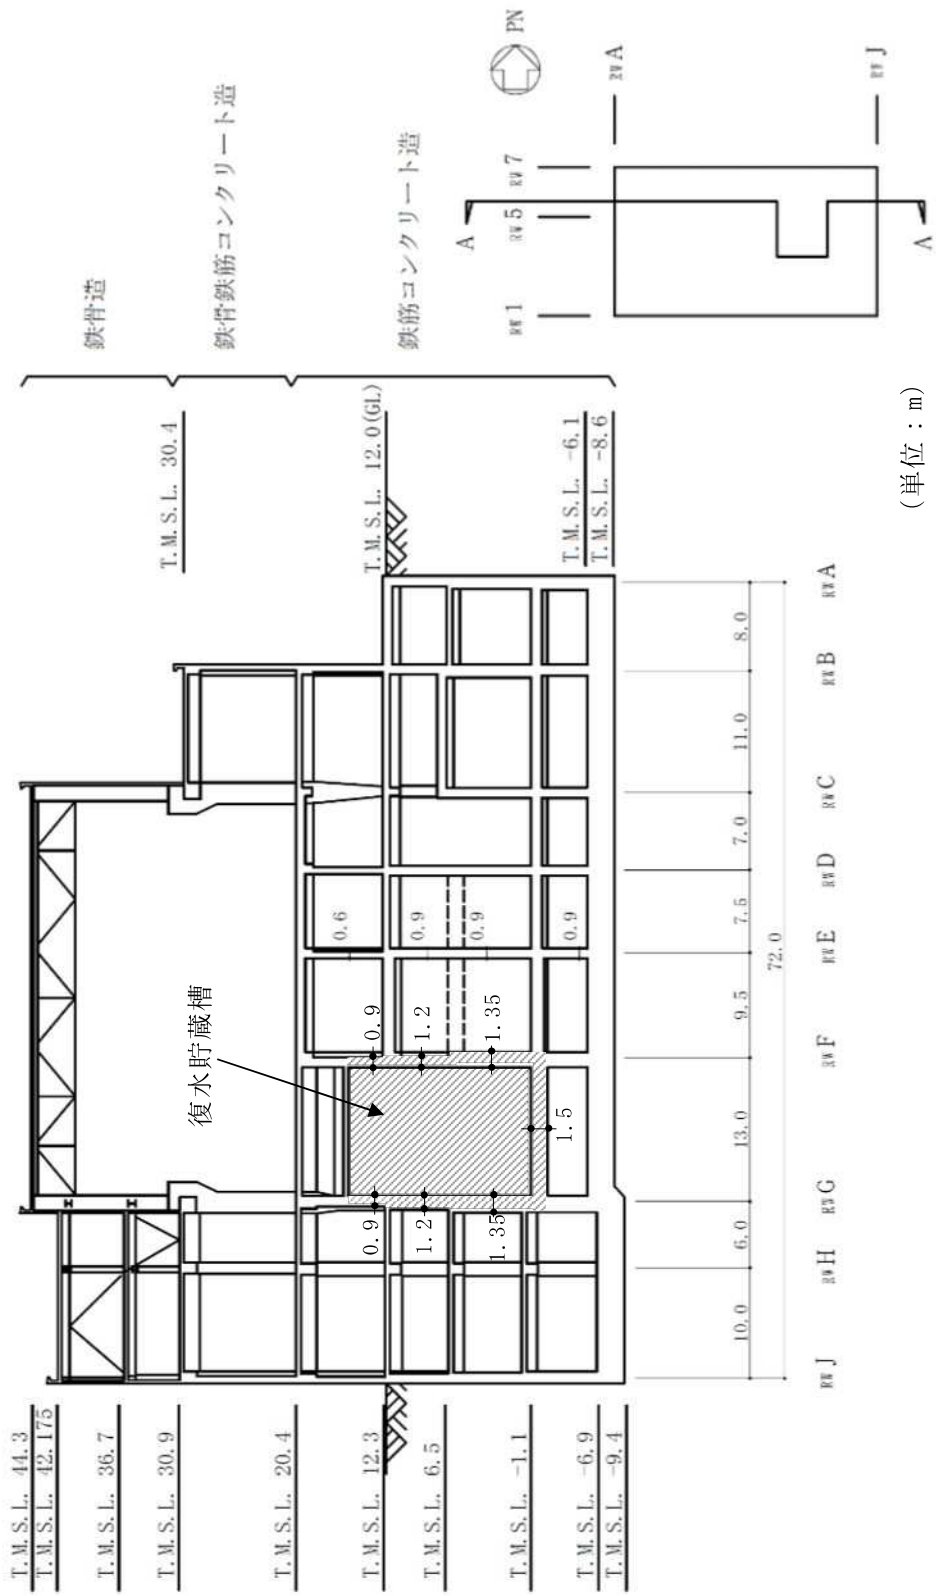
復水貯蔵槽を含む廃棄物処理建屋の概略断面図
